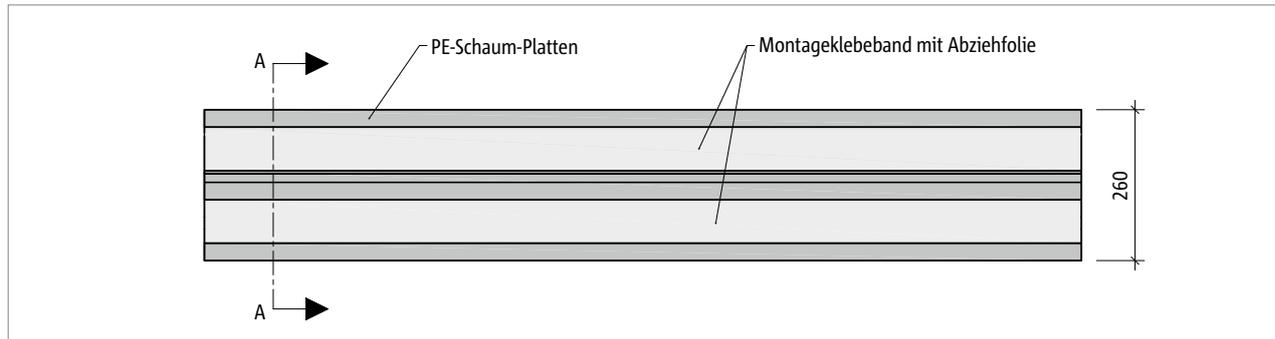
Schöck Tronsole® Typ F: Ansicht
